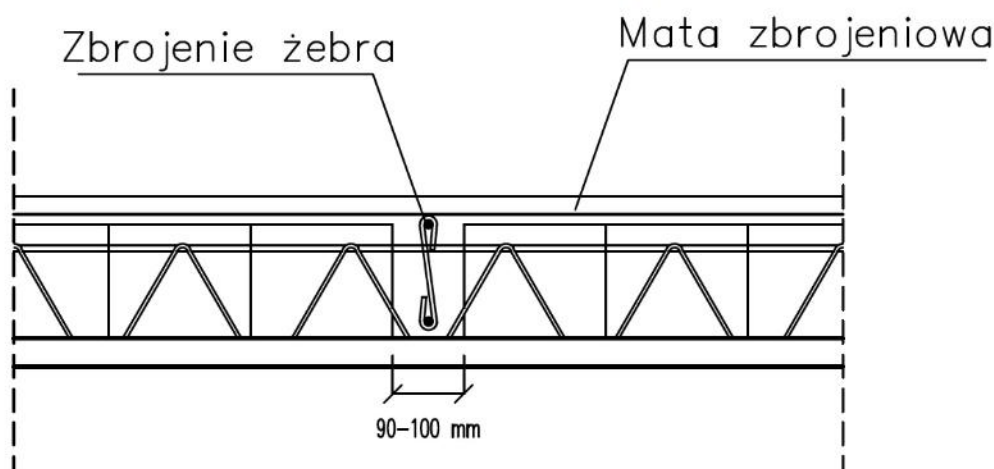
Przypadek wzmocnienia przez nakładające się kratownice przestrzenne umiejscowione w betonie układanym na budowie.
